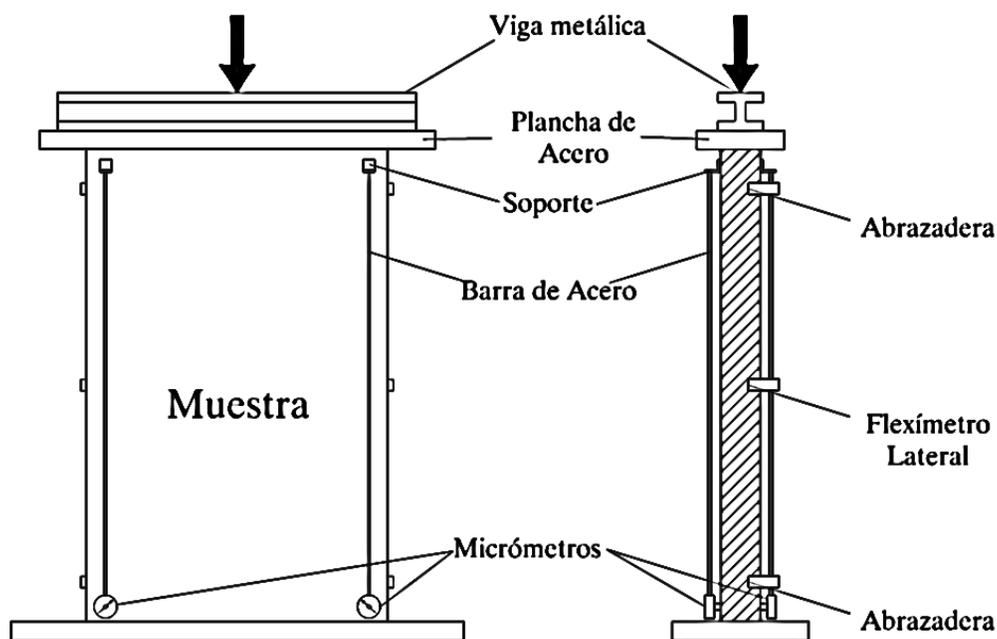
Ensamblaje del Equipo usado para el ensayo a compresión. Fuente: Elaboración Propia
